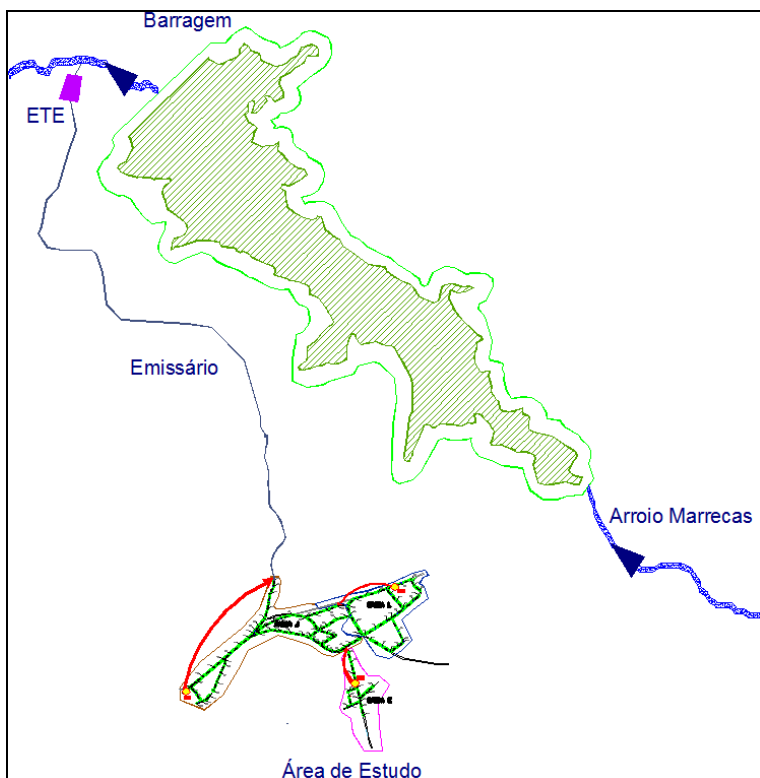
Layout do sistema de esgotamento sanitário de Vila Seca
